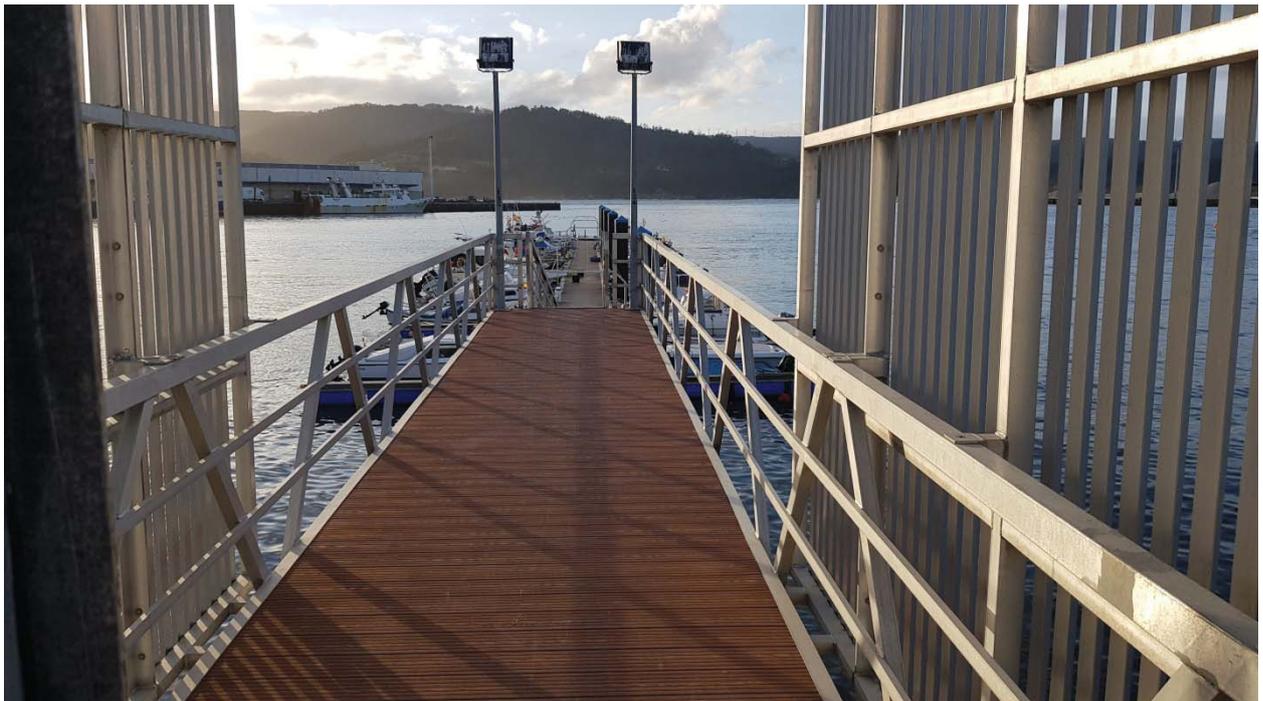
Vista del estado del pavimento de la pasarela fija de acceso al pantalán 2.
